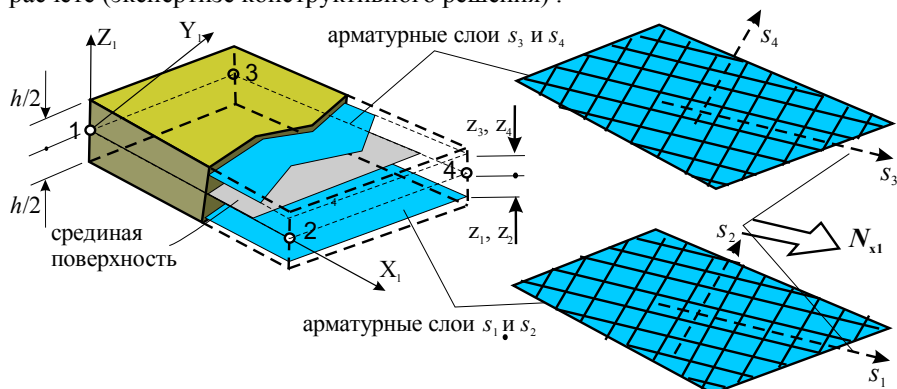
Четырехузловой конечный элемент для расчета железобетонной конструкции
